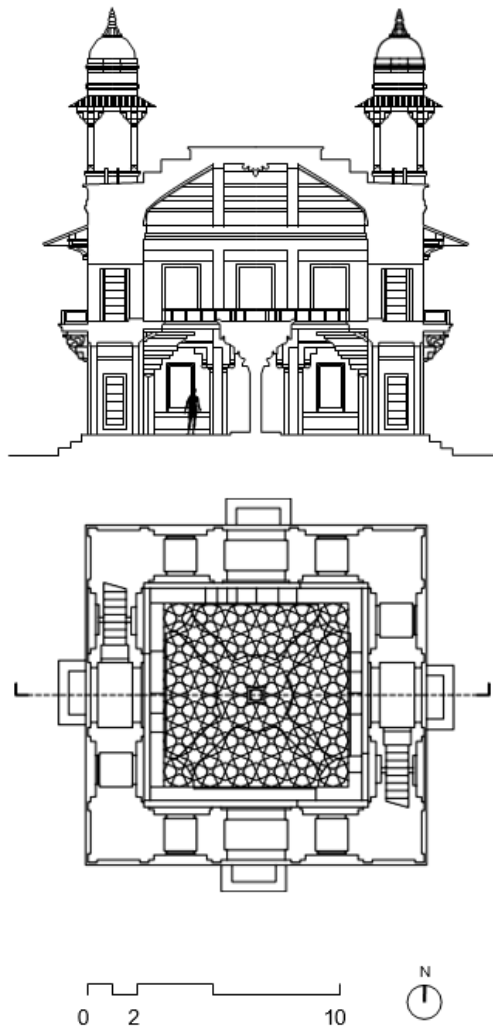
Planta y sección del Diwan I Khass. Dibujado por los autores del artículo con medidas tomadas in situ.
